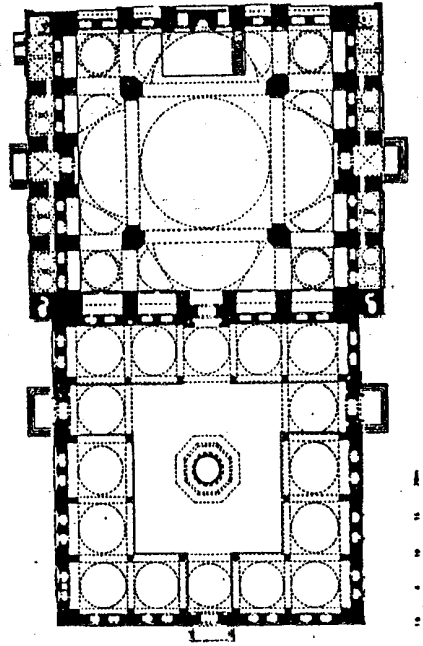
مسقط أفقي لجامع الفاتحية الصغير في أثينا باليونان
